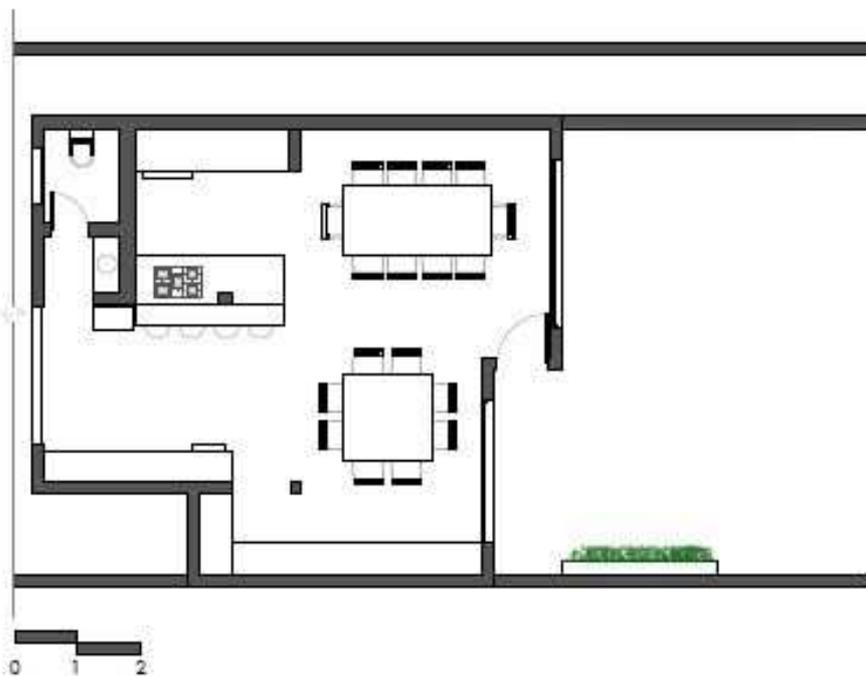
PLANTA ESQUEMÁTICA. FONTE: O AUTOR (2013)
